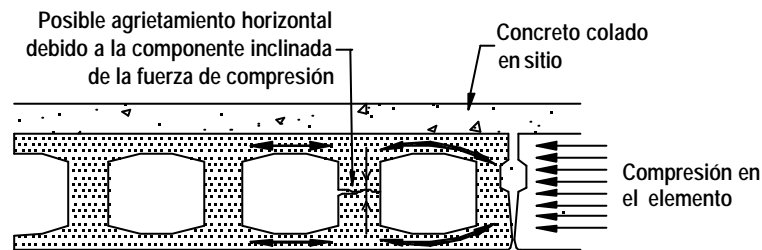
Posible agrietamiento debido a compresión en losas extruidas (Guidelines, 1991)
